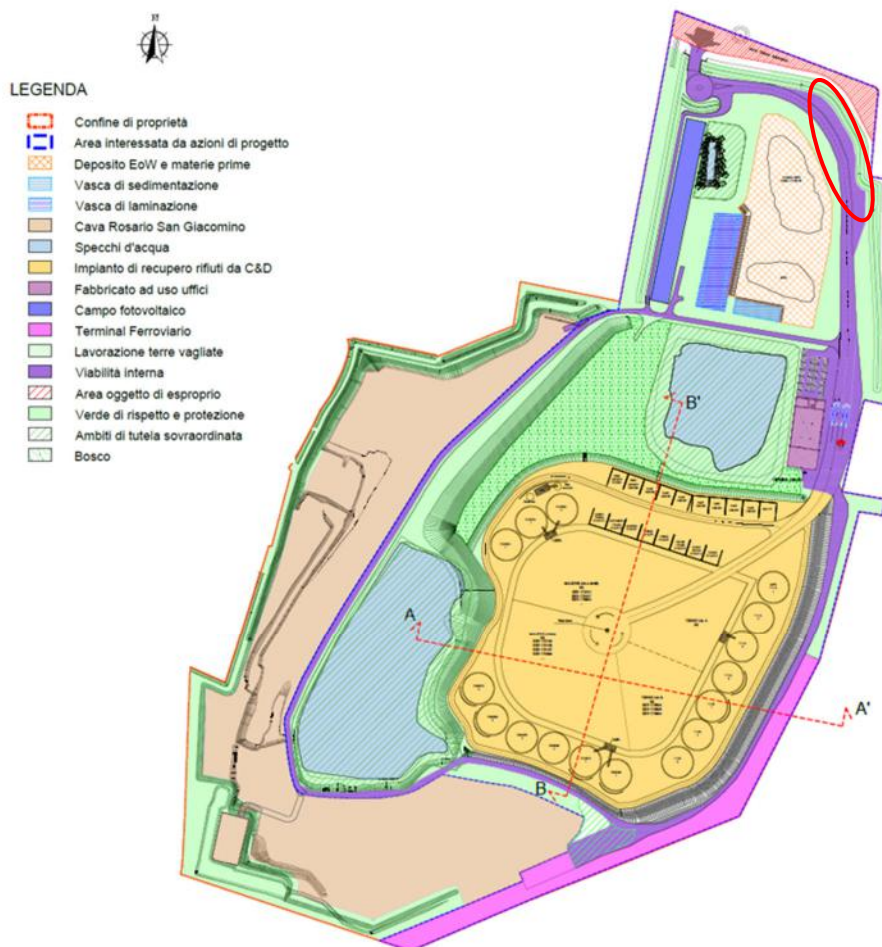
Individuazione area sosta automezzi (stralcio Tav. PF T11)
